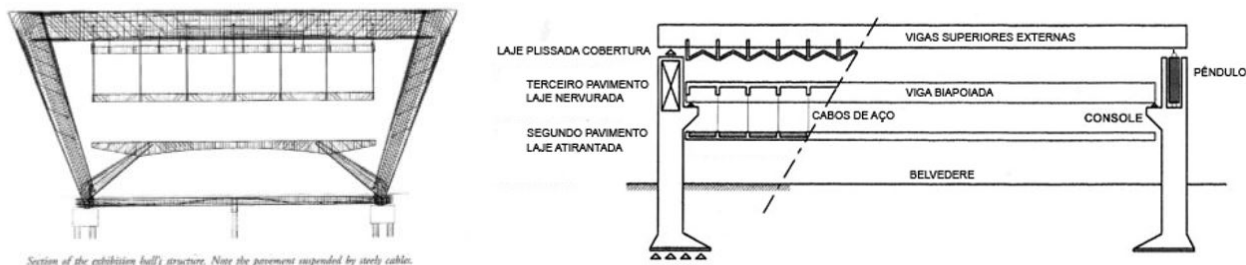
Corte transversal MAM-RJ, Affonso Reidy; Corte longitudinal MASP, Lina Bo Bardi
